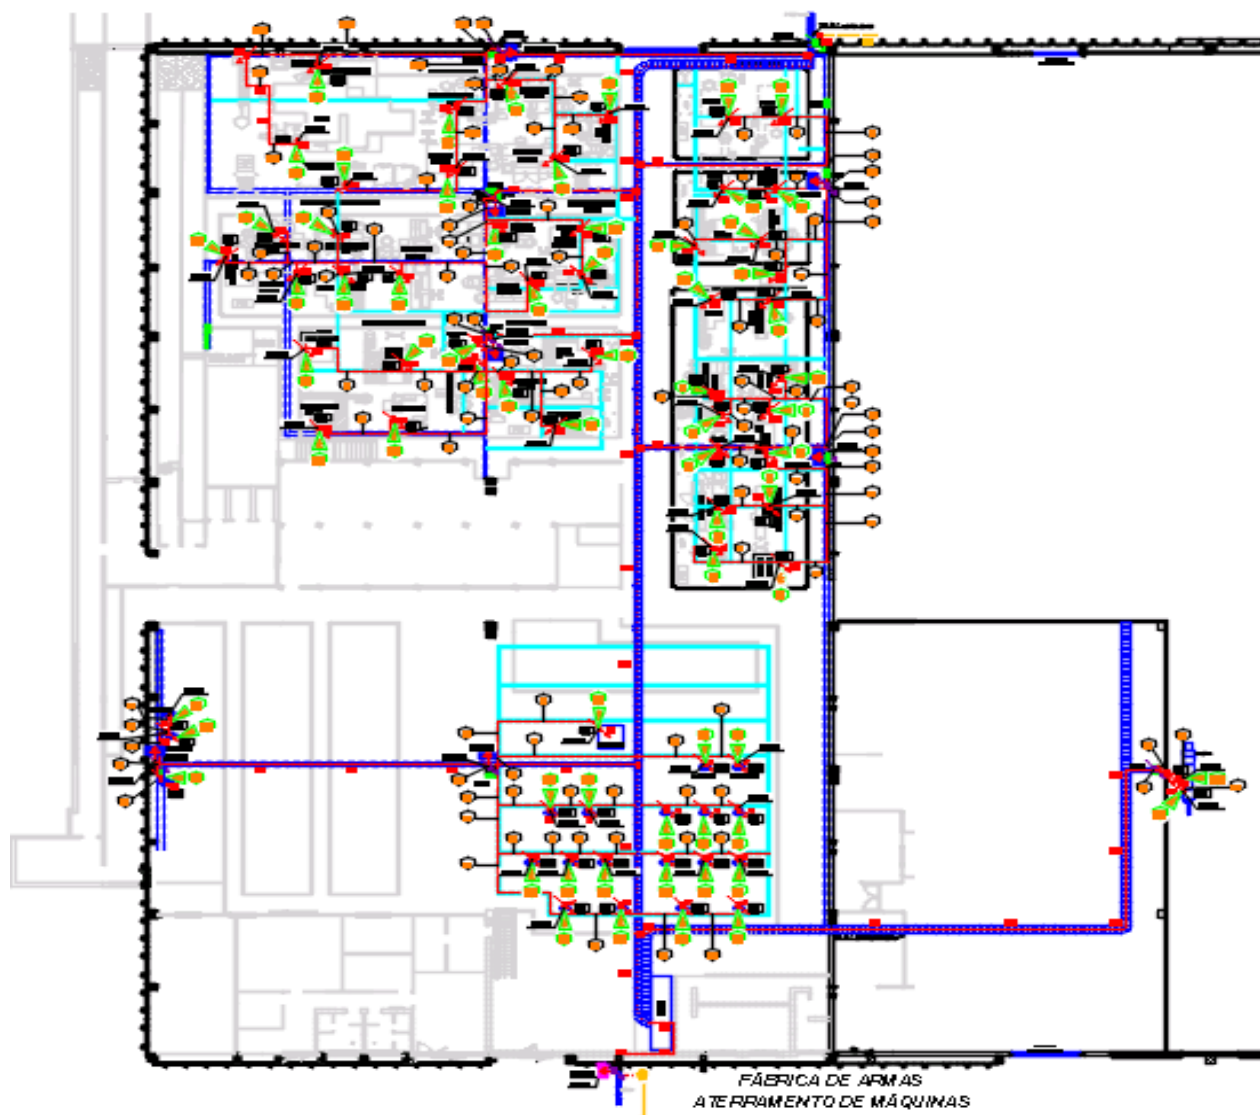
Croqui da planta dos pontos de aterramento instalados em máquinas/Equipamentos onde foram executadas as Medições de Resistência de Aterramento - (Ver planta DE-9639-001, em anexo).
